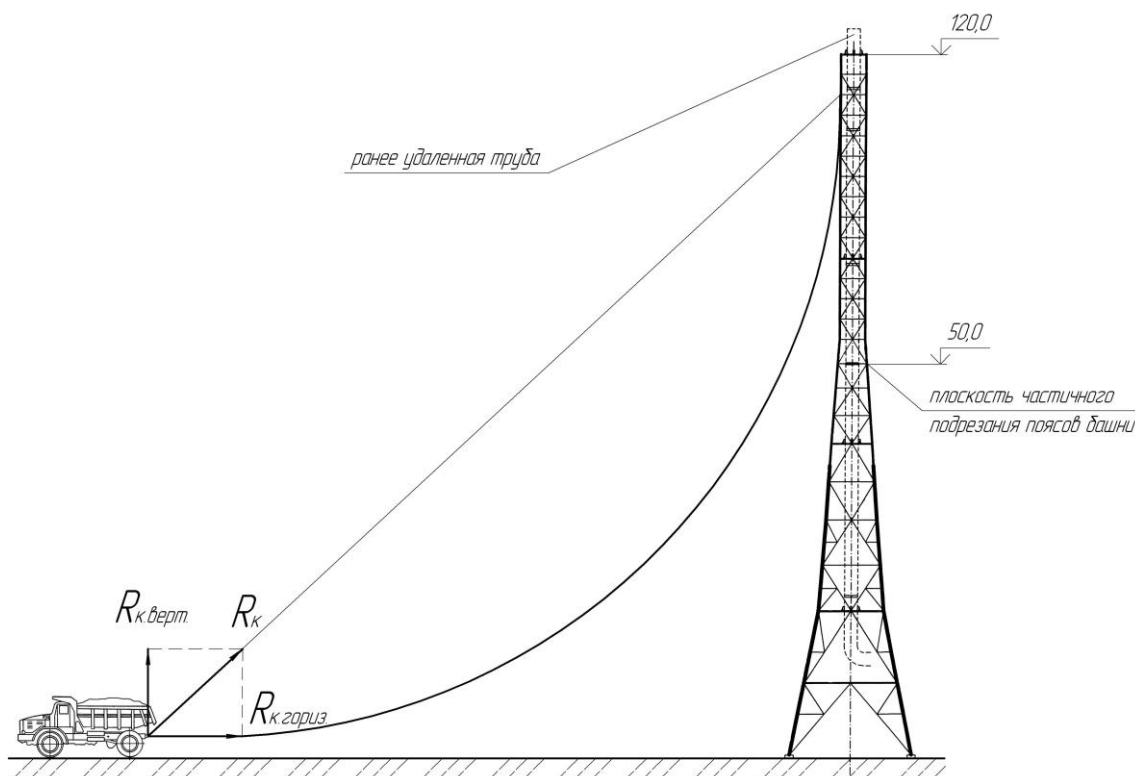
Схема обрушения металлоконструкции башни трубы
